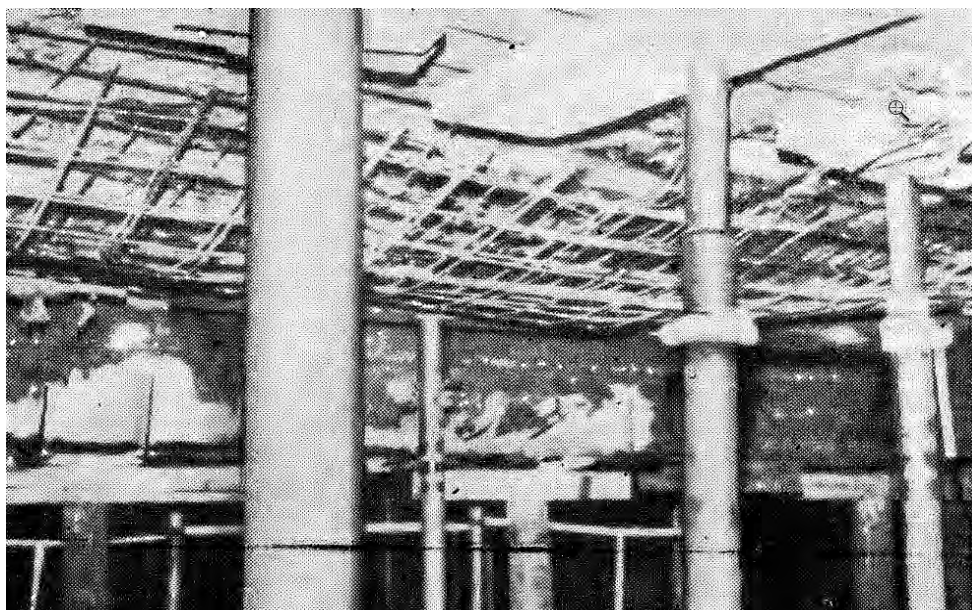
Разрушение бетонного потолка и прогибы арматурной сетки вследствие длительного воздействия открытого огня (Г. Руфферт. Дефекты бетонных конструкций.)
